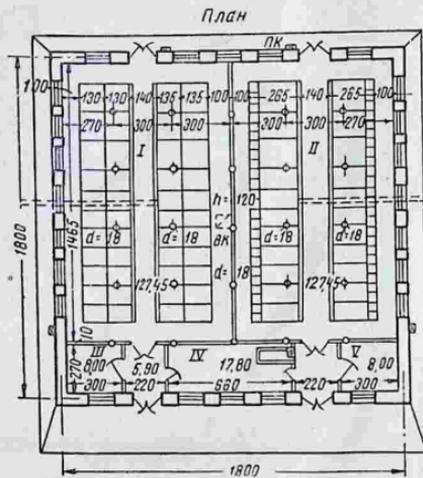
План шестирядного телятника к ферме на 100 коров:
